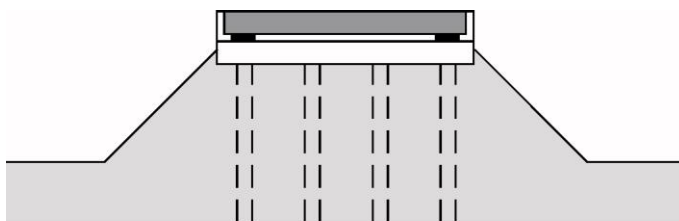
Estribos enterrados, columnas o pilotes con viga cabezal
